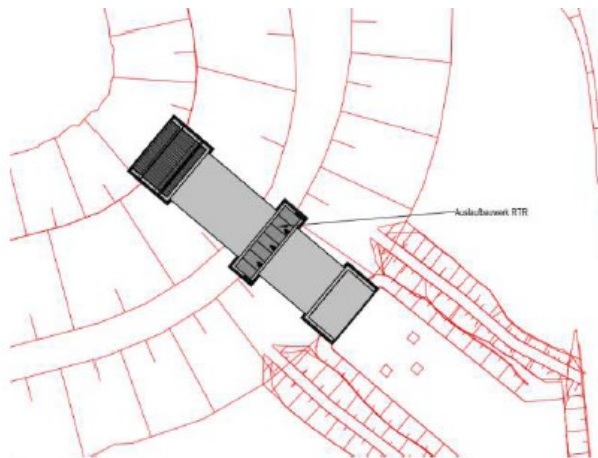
Grundriss des Auslaufbauwerkes ([13], Kap.7.5.2, Abb.38)
